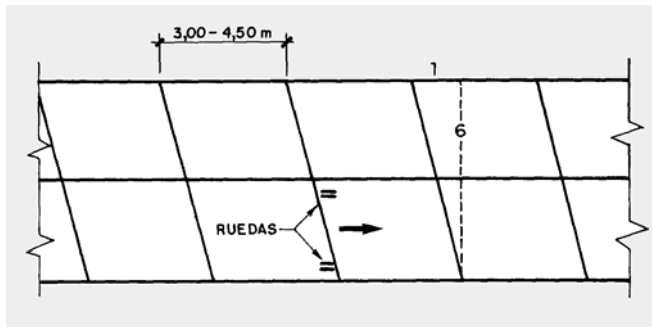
Pavimento de hormigón en masa con juntas transversales inclinadas
